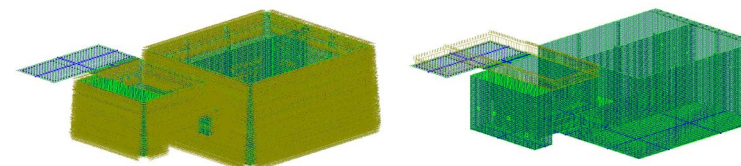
Нагрузка грунта на стенки (слева) и нагрузка от здания (справа)
